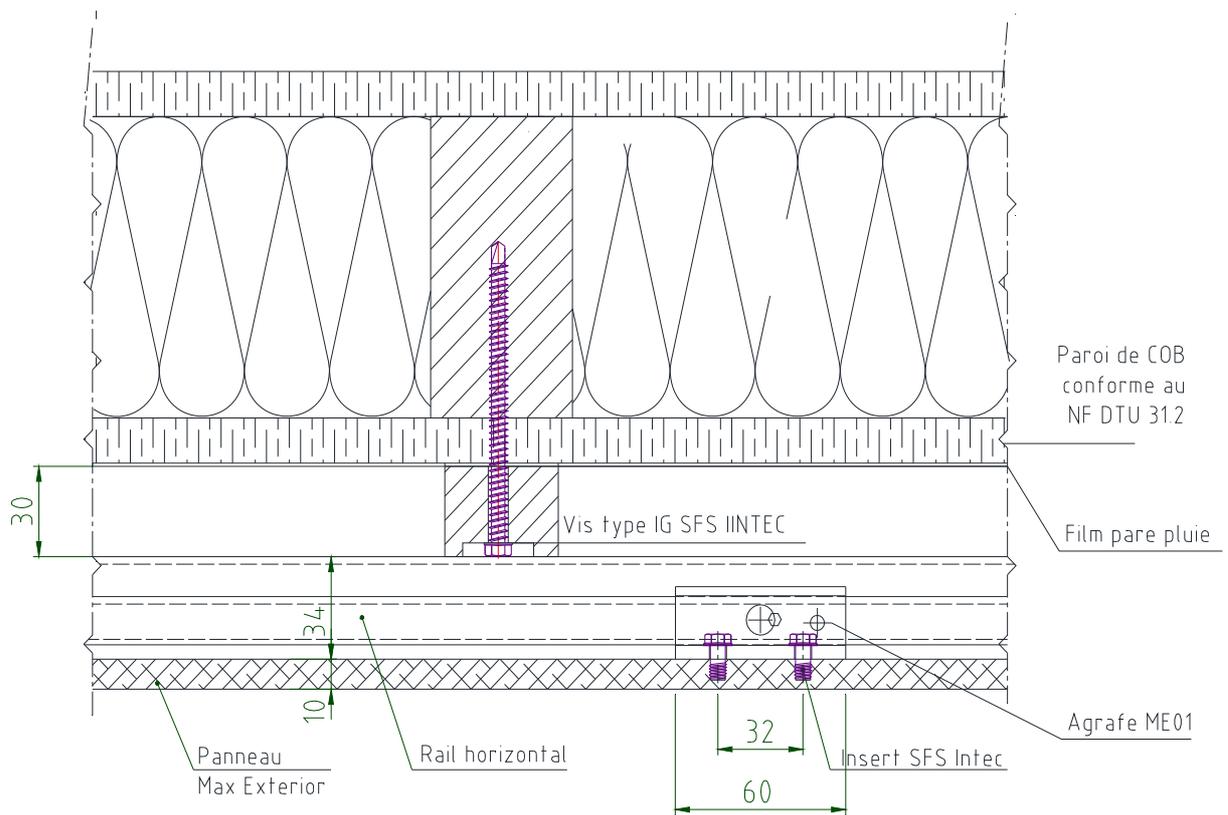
Détail fixation du tasseau sur montant COB (Coupe horizontale)
